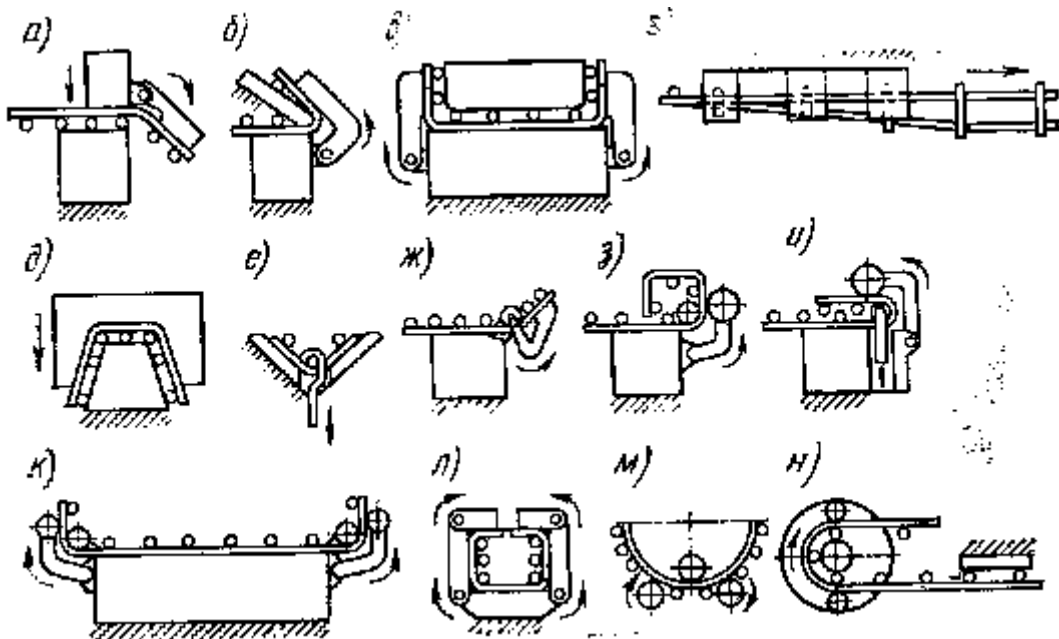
Основные типы машин для гибки арматурных сеток
